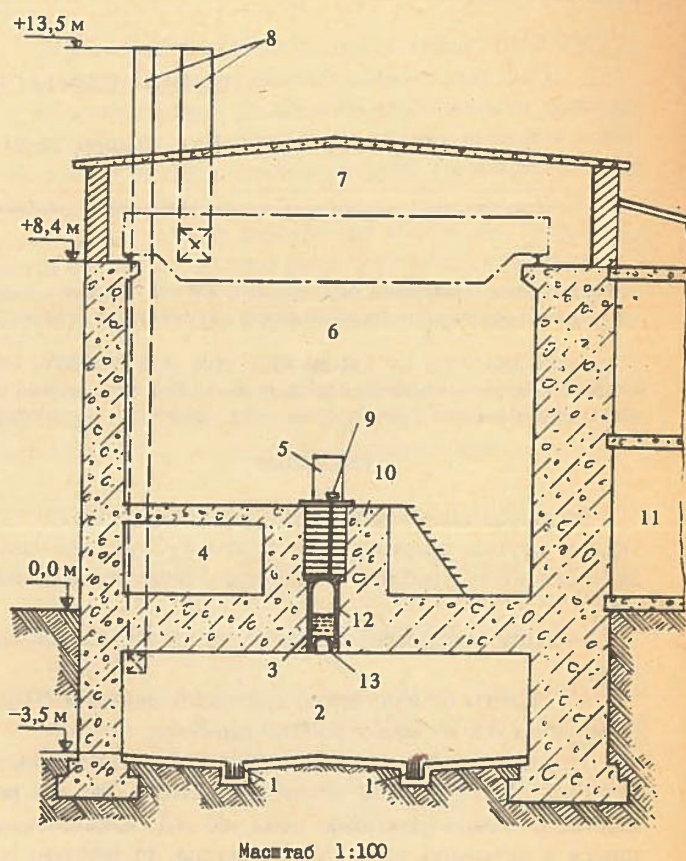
Схематический вертикальный разрез помещений реактора ВИР-2М: 1 — приемники топливного раствора; 2 — нижний реакторный зал (объем 250 м³); 3 — топливный раствор; 4 — бункер газового контура; 5 — механизмы управления; 6 — верхний реакторный зал (объем 1760 м³); 7 — мостовой кран; 8 — трубы вытяжной вентиляции реакторных залов; 9 — топливный канал; 10 — блок биологической защиты; 11 — пультовая; 12 — корпус АЗ; 13 — реактор ВИР-2М
